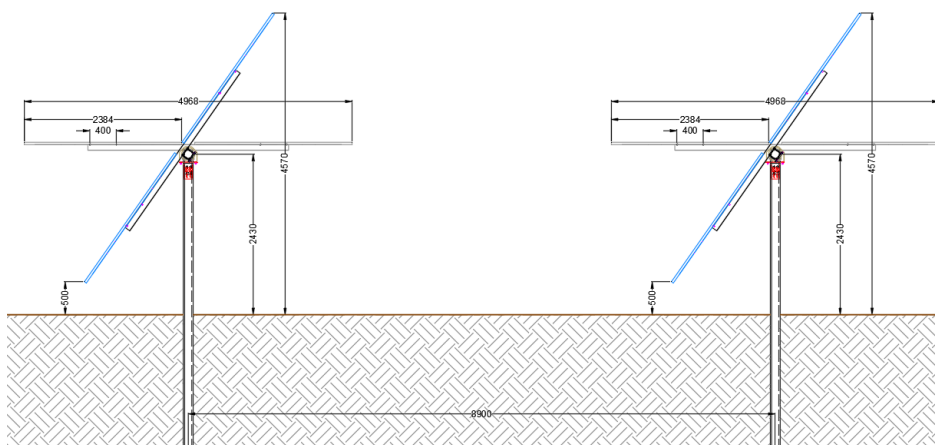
Distanza interasse - interasse tra due tracker di 8,9 m
